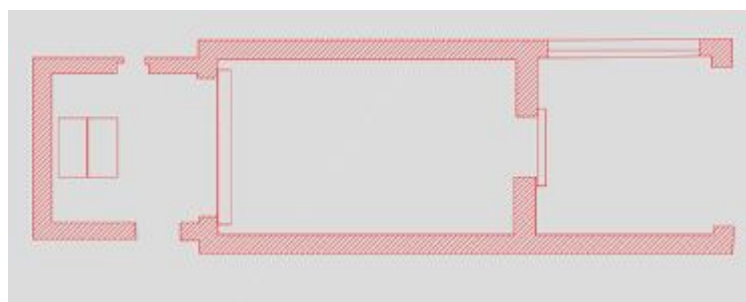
Pianta della Chiesa di S. Giovanni – ricostruzione su disegno datato 1578.
